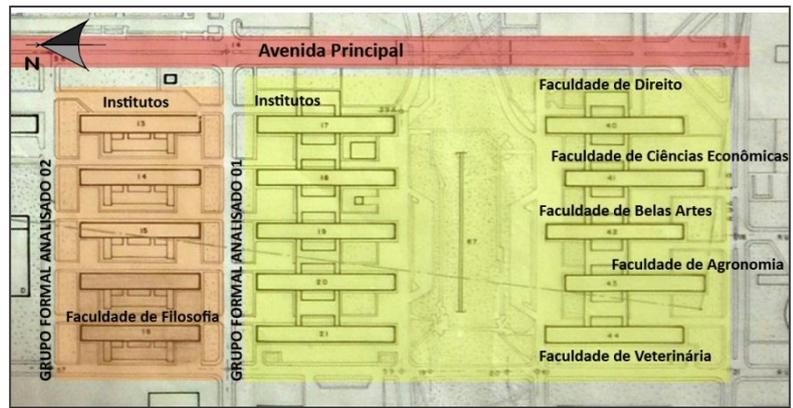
Planta do Conjunto de Institutos mais próximos ao lago (FONTE: A Autora, 2010).
